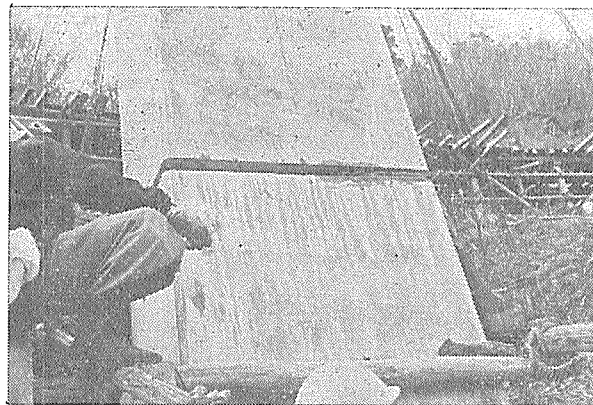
組立て一体化が完了し、上部主桁をのせ始めた下部工
